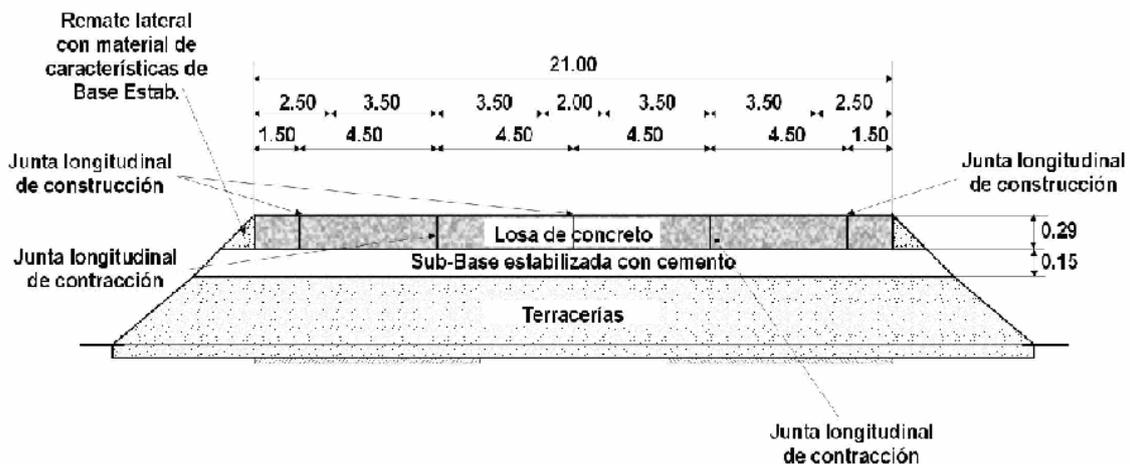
Sección tipo A4 de pavimento de concreto hidráulico.
